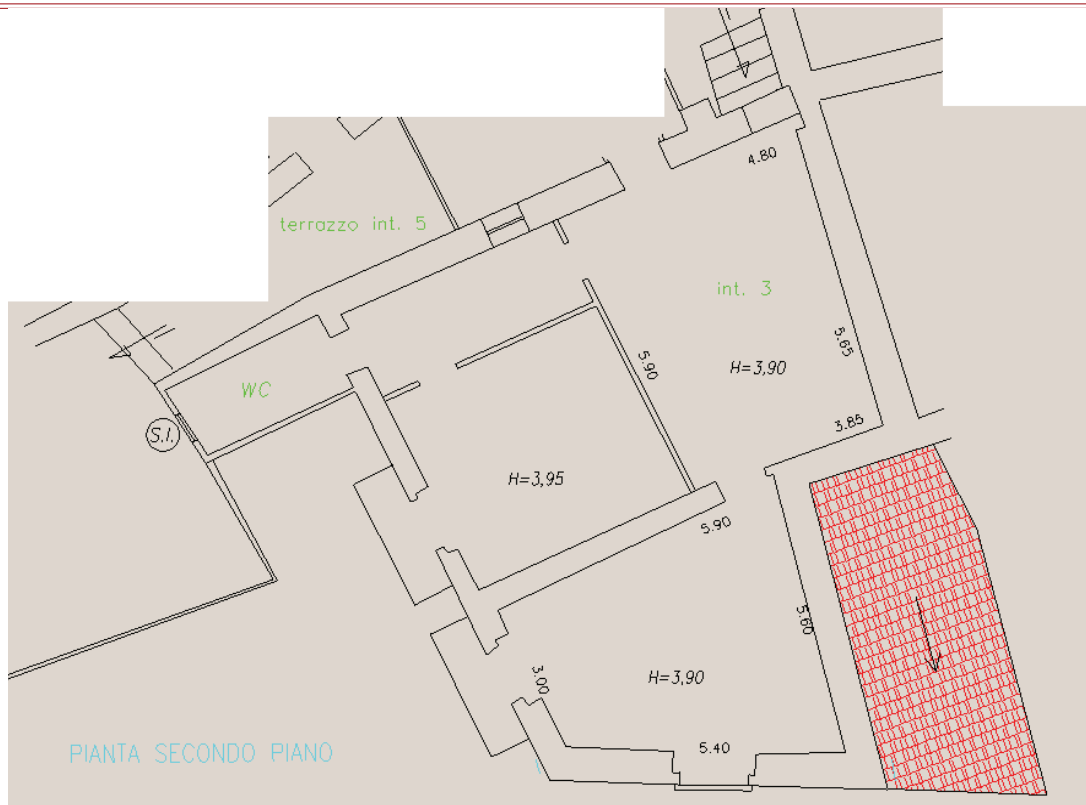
Planimetria dell'appartamento int. 3 di cui al sub-Lotto E1 piano *secondo
